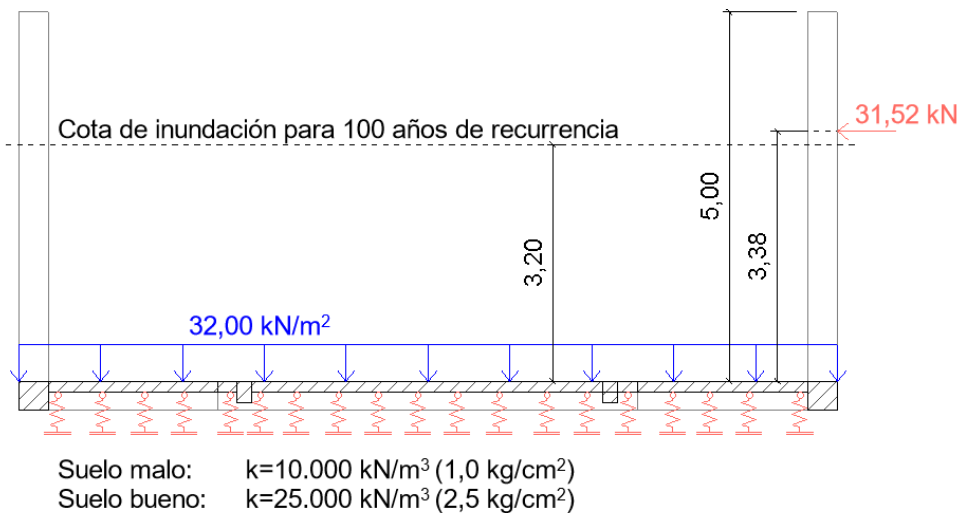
Cargas utilizadas para el diseño de la platea con el pontón flotando.
